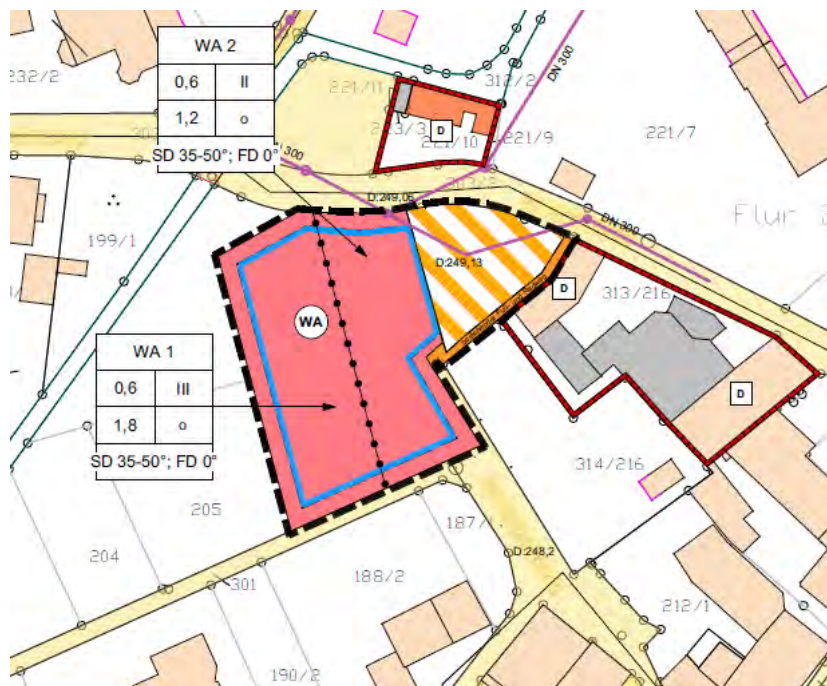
Ausschnitt Entwurf B-Plan vom 28.04.2021
